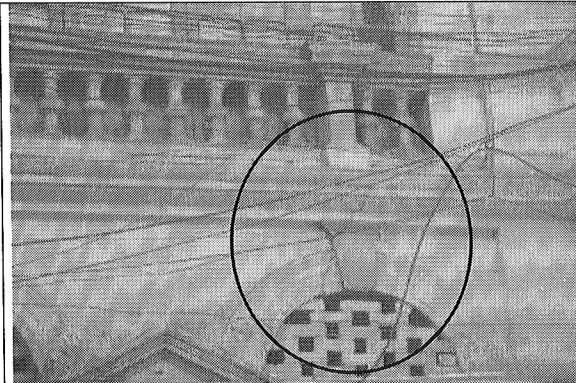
Agrietamiento en el muro de fachada costado oriental.
